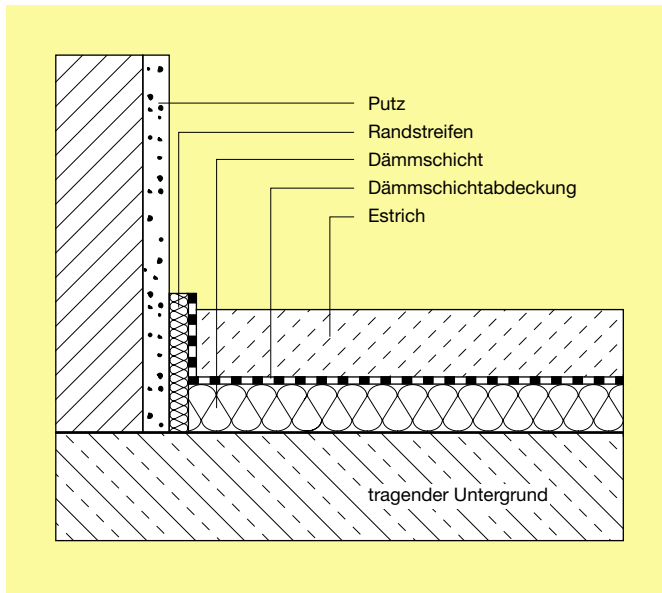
Estrich auf Dämmschicht, Wandanschluss [6]
